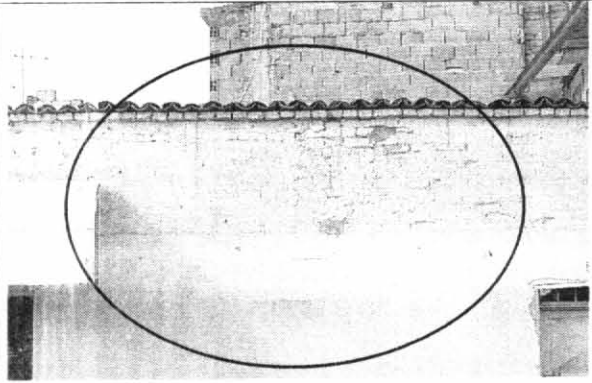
Agrietamiento leve del muro en la fachada del inmueble.
